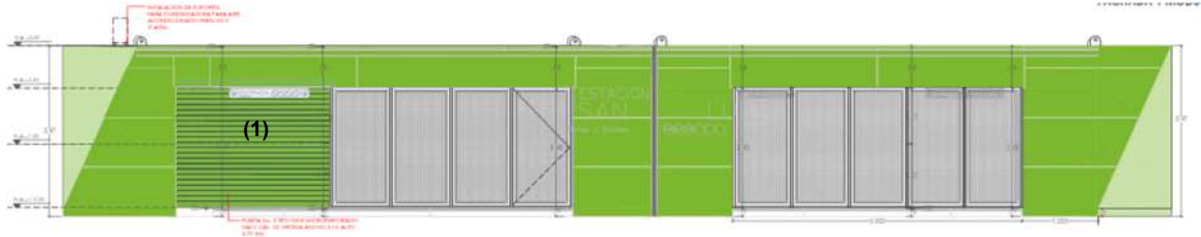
Ubicación puertas vagón acceso principal. Revisa plano 8. A-201 FACHADA GENERAL 1-2.dwg y 9. A-201A FACH GEN 1-2-cerrada.dwg
